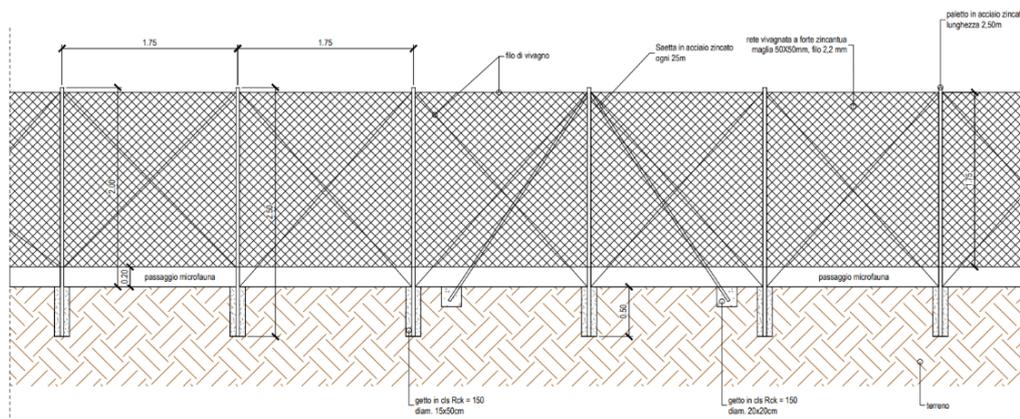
Schema tipo recinzione perimetrale campi fotovoltaici (estratto PRO\_TAV\_23).
